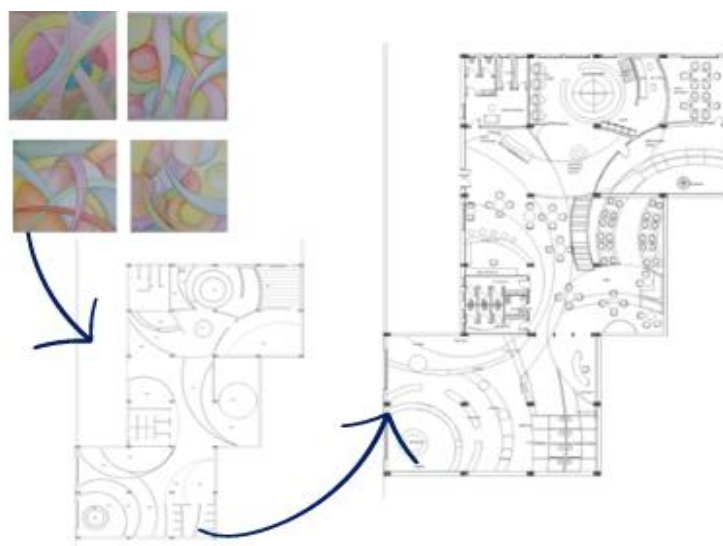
Exemple d'application du concept (après recherches de dépassement 2D) sur le plan -
